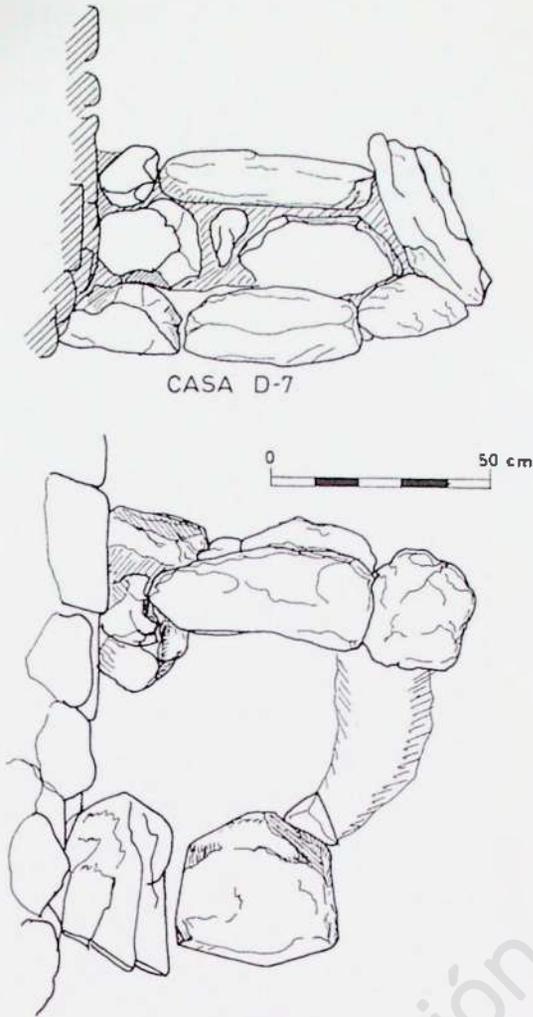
Detalle de la estructura de piedras de la casa D7. Planta y vista frontal de la pared interior occidental.
